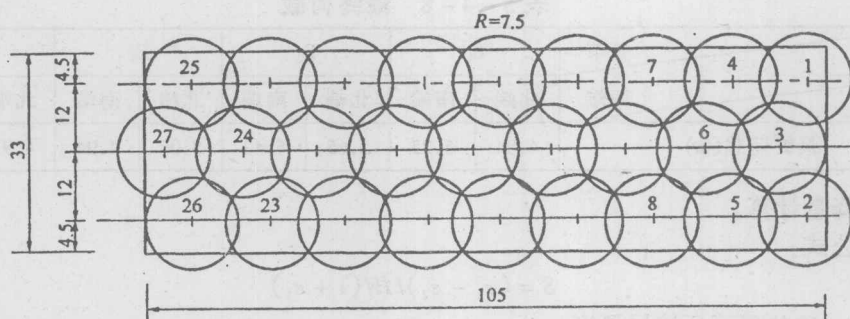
各管节压砂孔的平面布置图(尺寸单位:mm)
